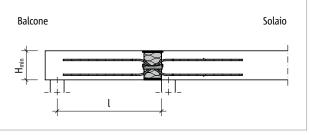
Schöck Isokorb® XT tipo QL-VV: schema statico (XT tipo QL-VV5 – VV8)
